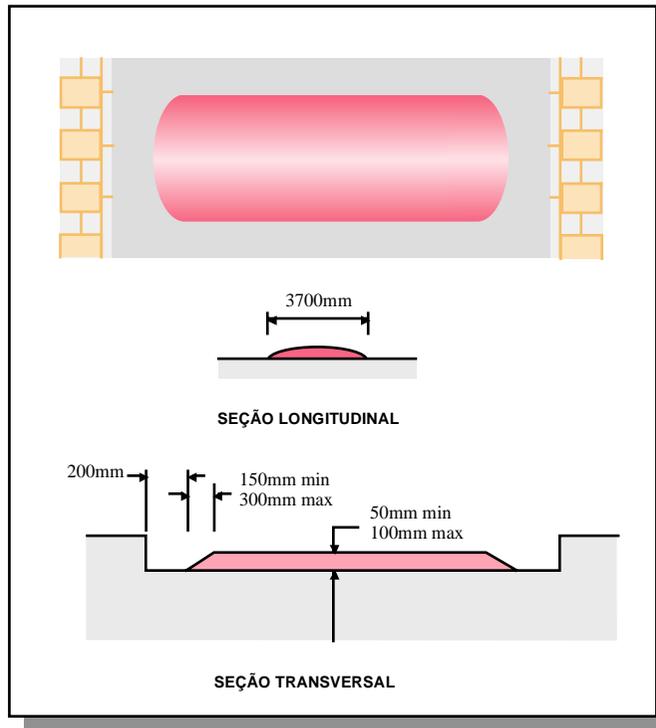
Ondulação de perfil circular padrão: planta, seções transversal e longitudinal.
